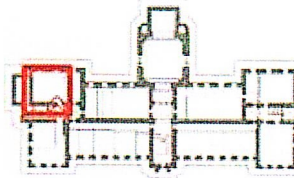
Междуэтажные плоские перекрытия, кирпичные перемычки оконных проемов
